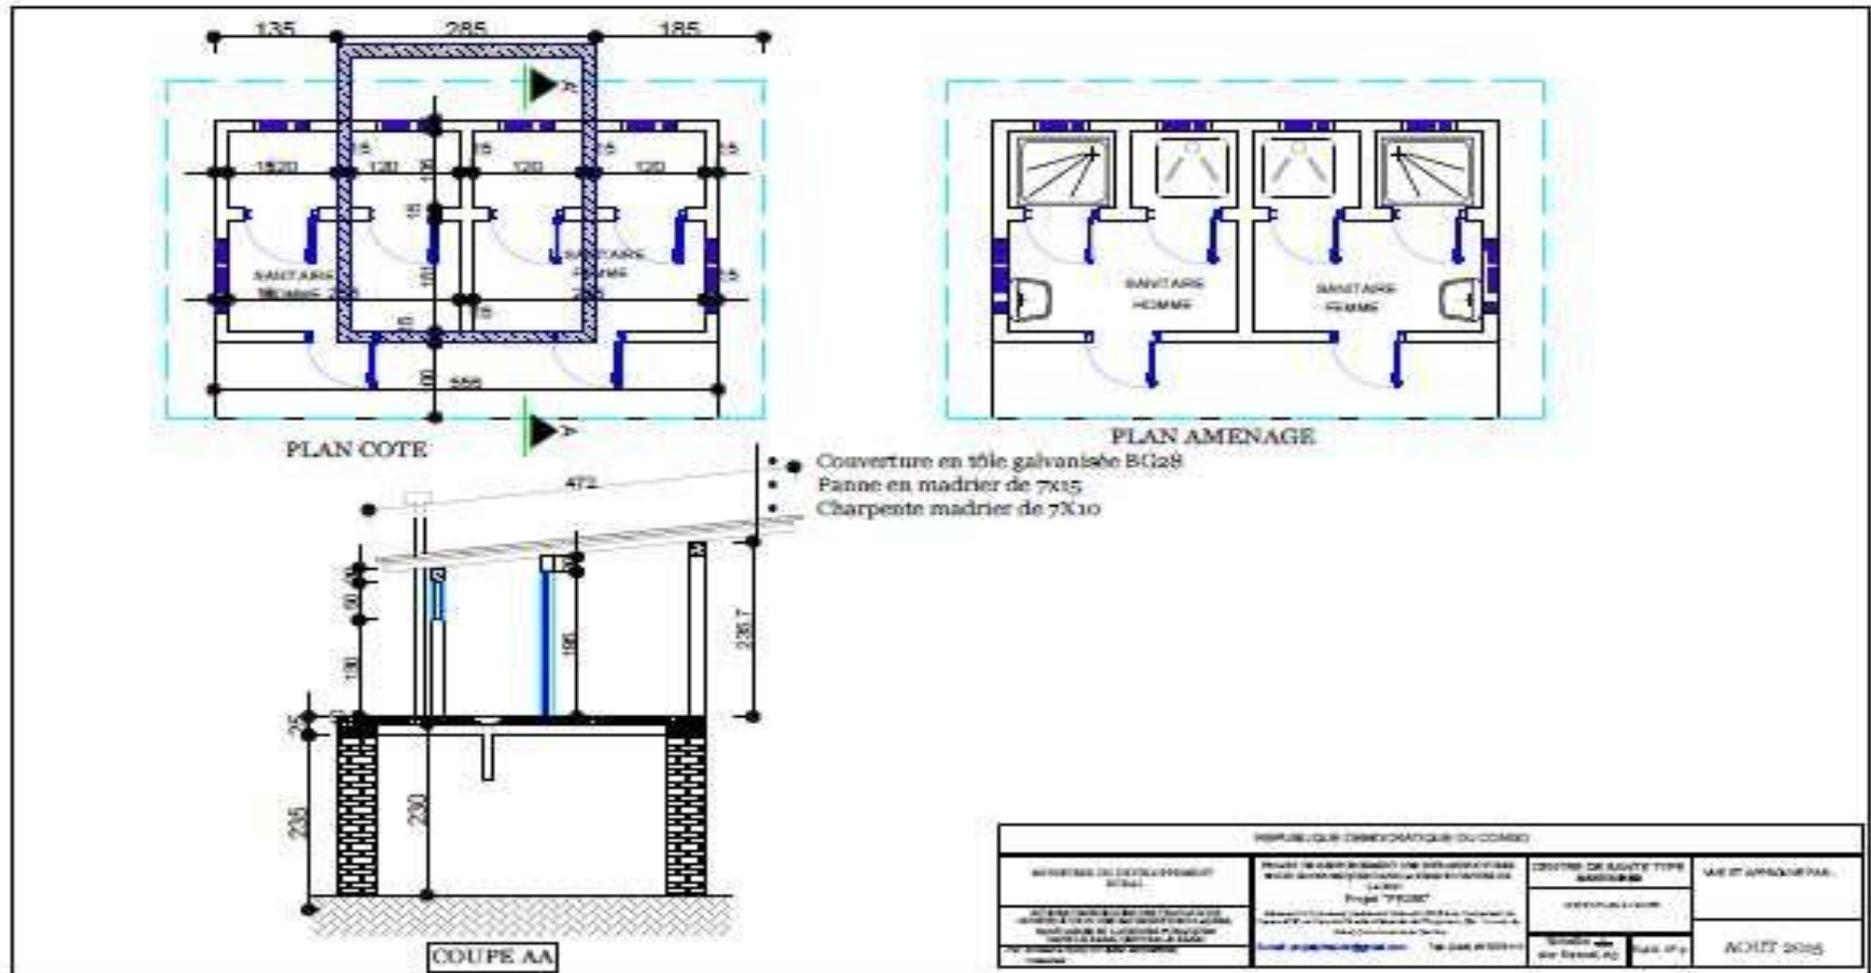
Le plan aménagé des sanitaires qui seront construits sur les sites des écoles
